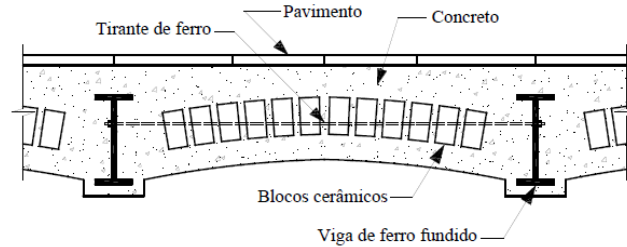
Sistema "filler joist" (MESQUITA, 2016)
